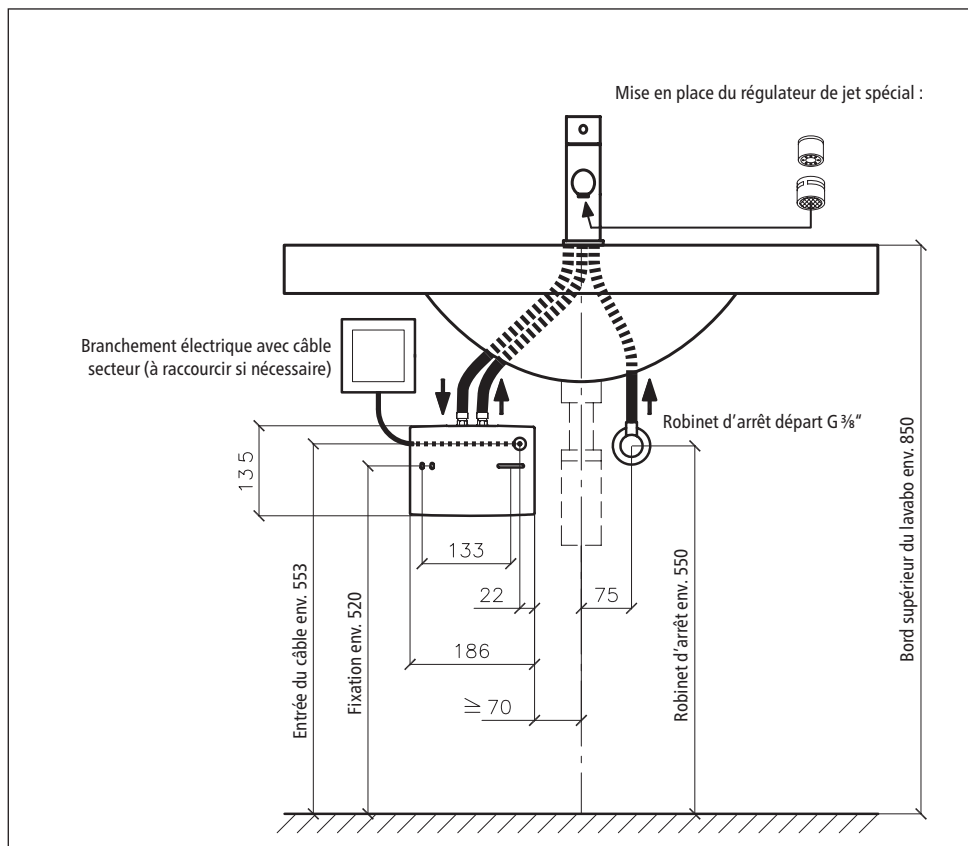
« Installation basse pression (écoulement libre) avec robinetterie pour appareils à eau chaude basse pression » (cotes en mm)
